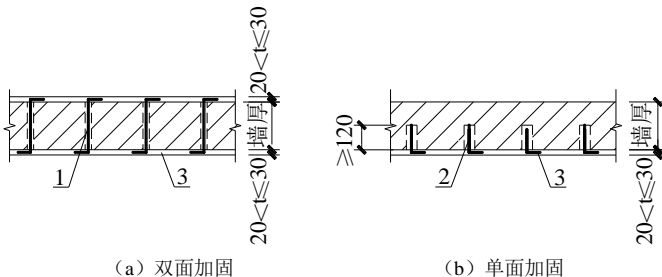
高延性混凝土面层设置拉结筋时的构造做法
